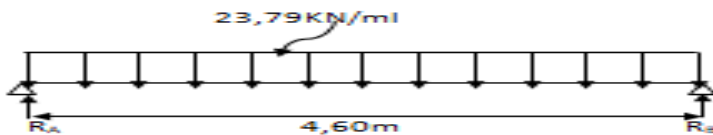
Schéma statique de la poutre palière à l'ELS
